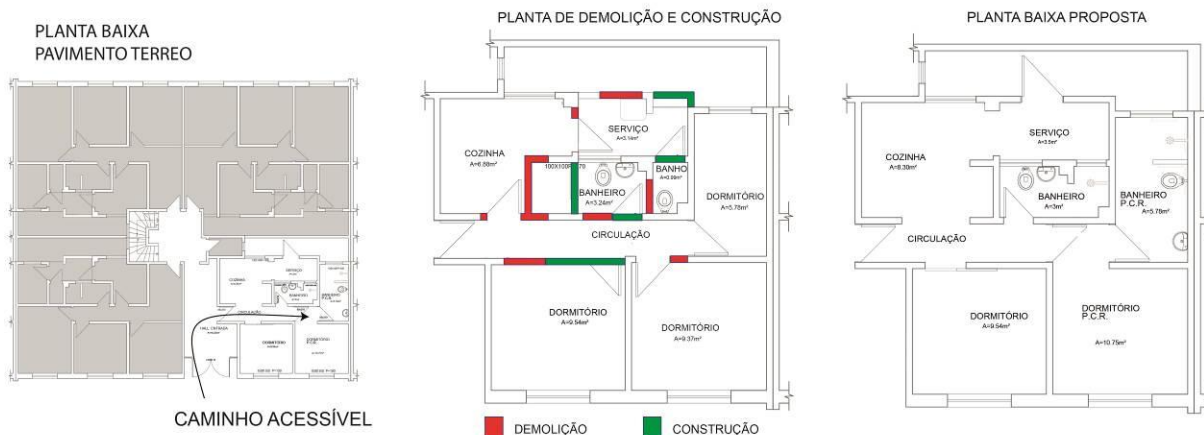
Bloco e prédio 34. Caminho acessível bastante próximo a entrada da edificação. Planta de demolição e construção de paredes, bem como o novo *layout* proposto.
